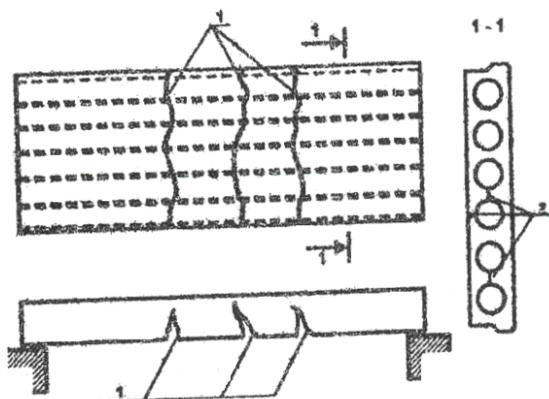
«Силловые» и технологические трещины в пустотной панели перекрытия:
